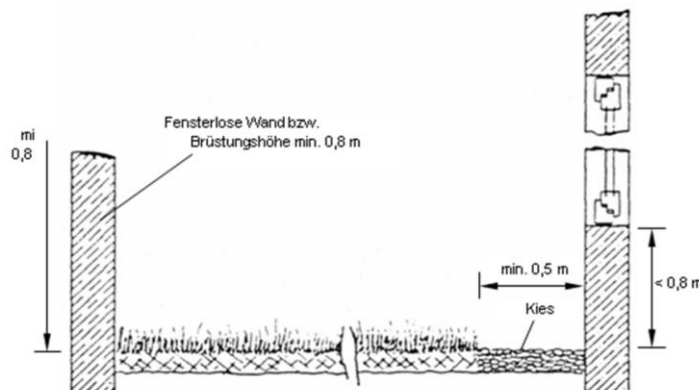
Ausführung Gründach vor aufgehenden Wänden mit Öffnungen
